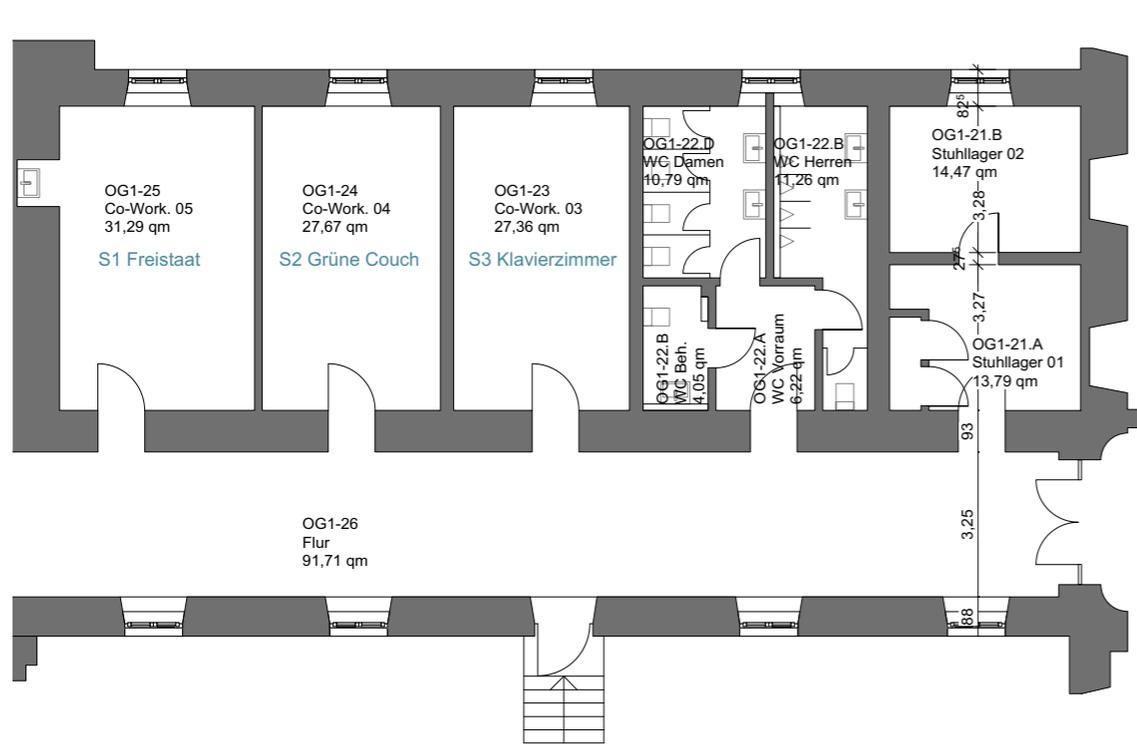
Grundriss Gewerbeeinheiten
